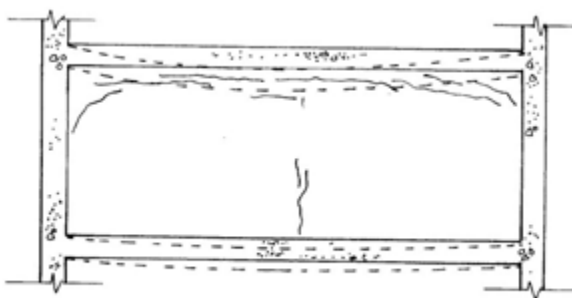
Fissuras provocadas porque a flecha da viga suporte é menor que a da viga superior¹⁸
